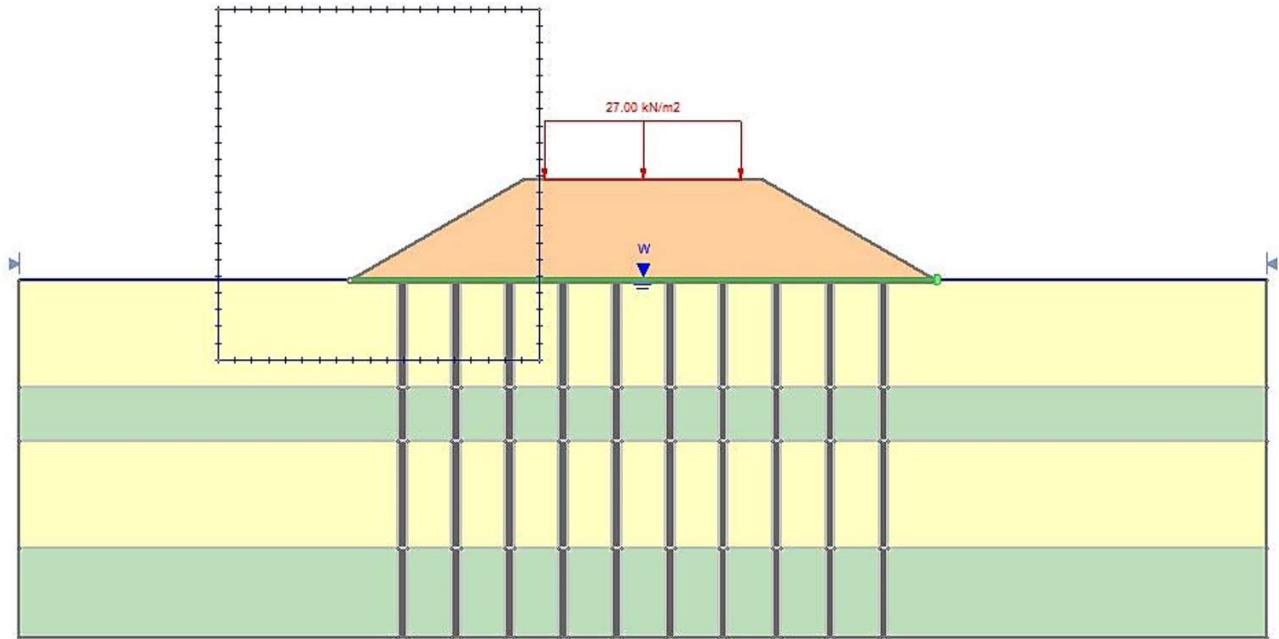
RILEVATO IN ZONA ARMELLINA – H = 5,6 M – SCHEMA DI CALCOLO
